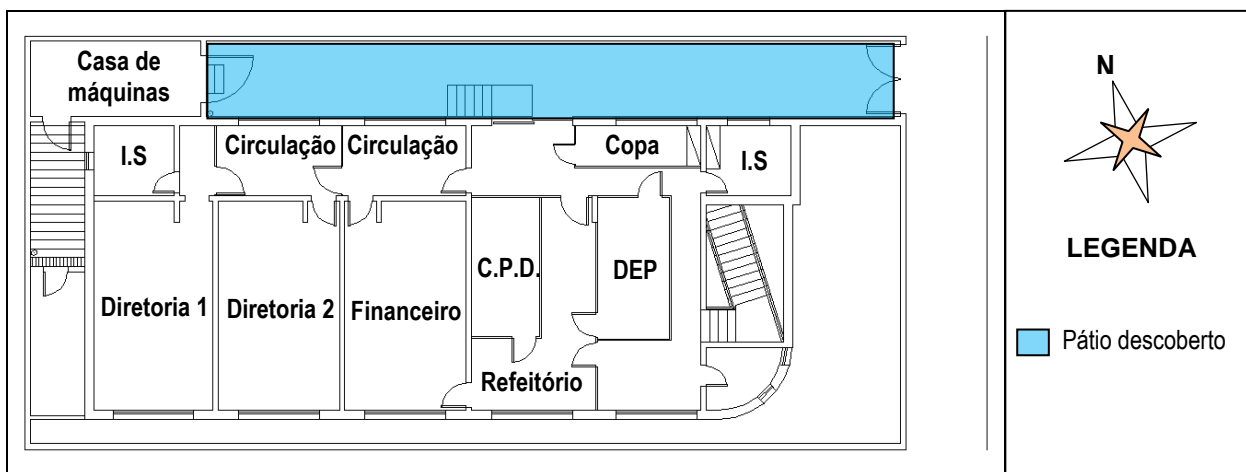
Pátio descoberto existente no empreendimento (2º Pavimento)
